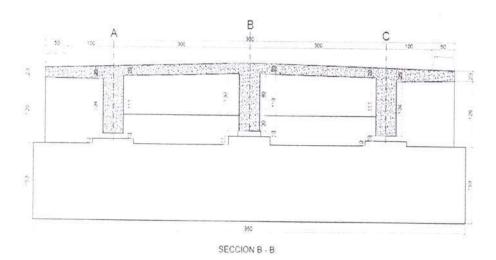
Sección longitudinal de puente Quebrada Seca
